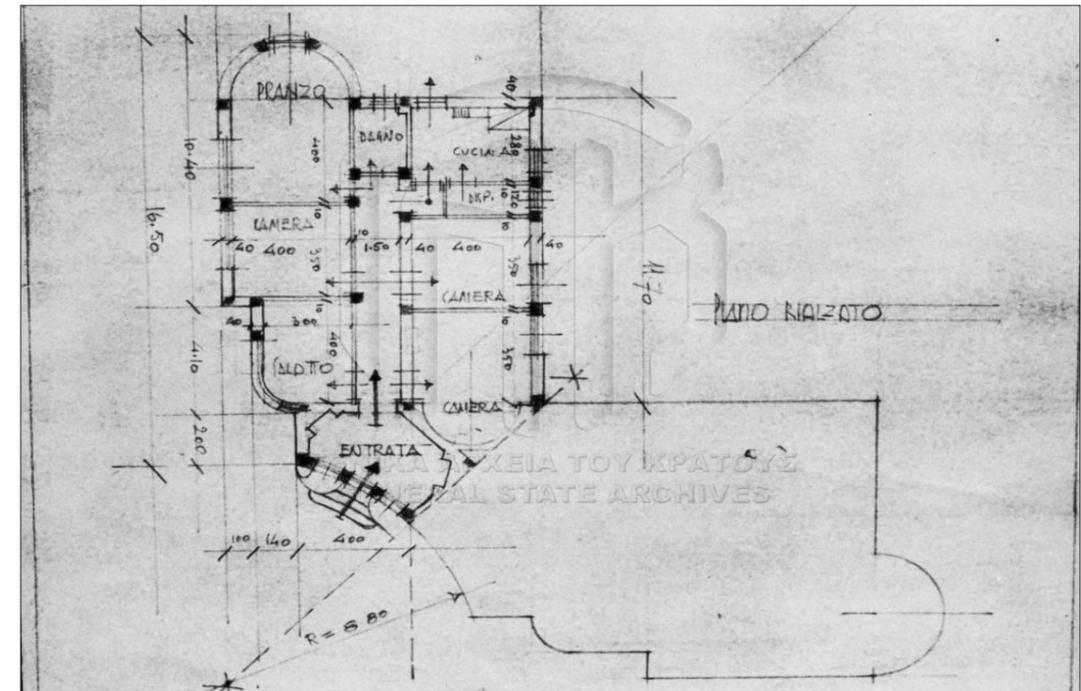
casa ufficiali A1, pianta pt sc. 1:100
